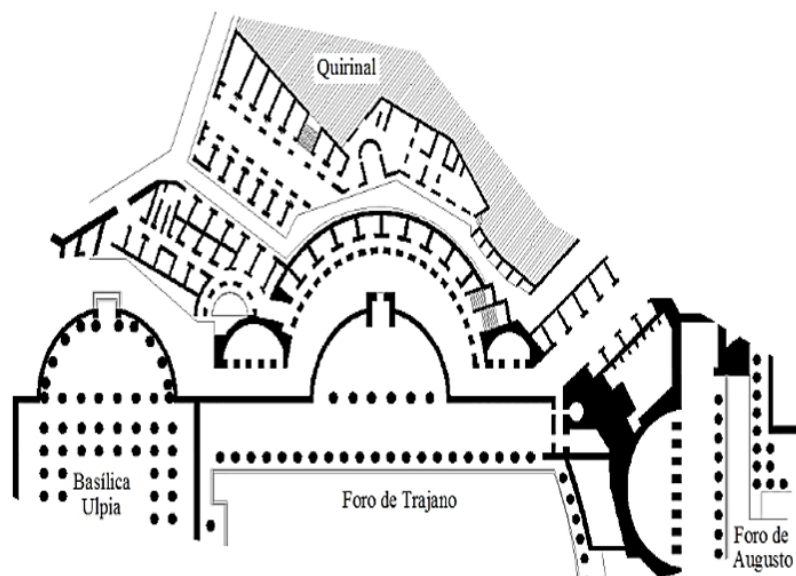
Fórum de Trajano - Planta em hemiciclo.
